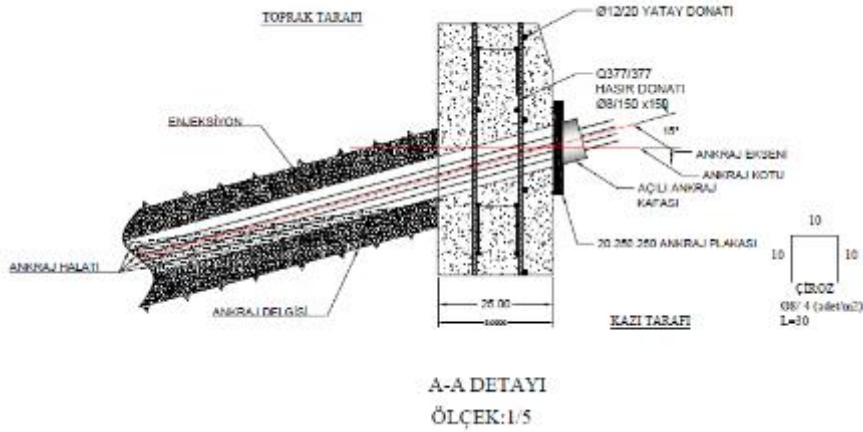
Zemin Çivili Püskürtme Beton Cephe ve Kesit Görünüşü
